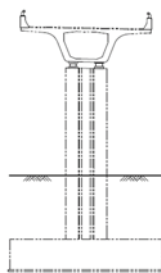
和美交流道匝道一高架橋標準斷面圖
